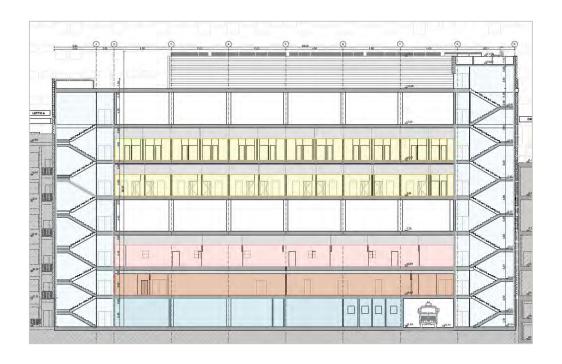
CORPO VOLANO: SEZIONE LONGITUDINALE
